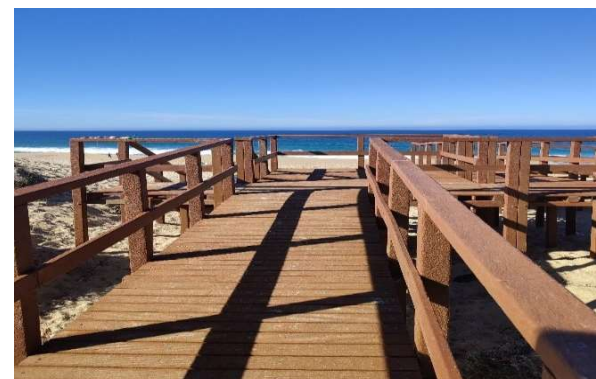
e 19 – Fotografias finais da obra de alteamento do passadiço
